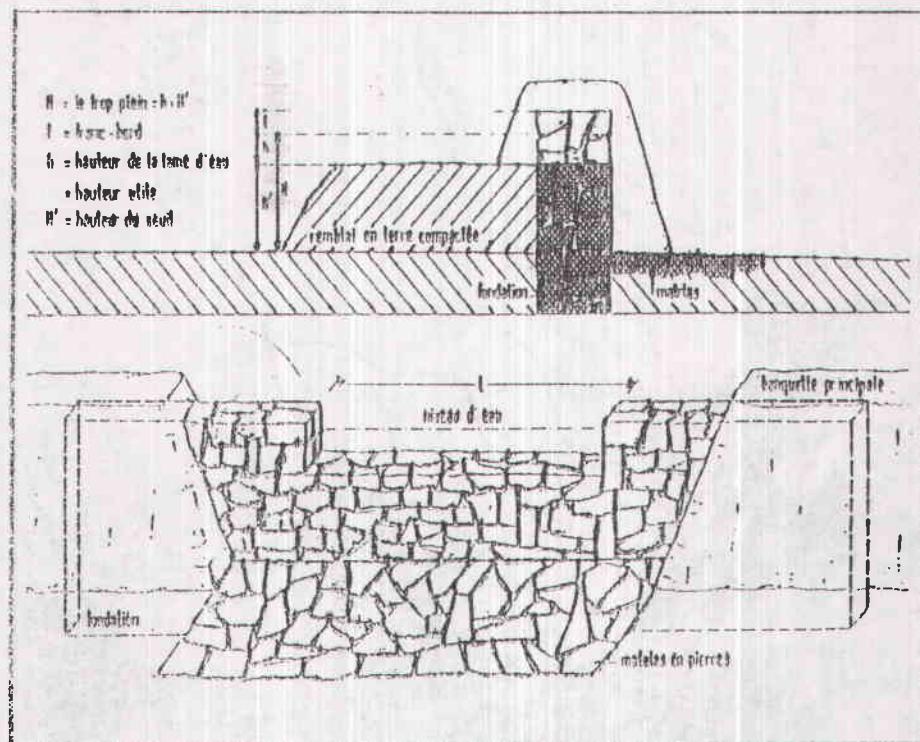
Senil-déversoir. Section transversale et perspective extérieure.
